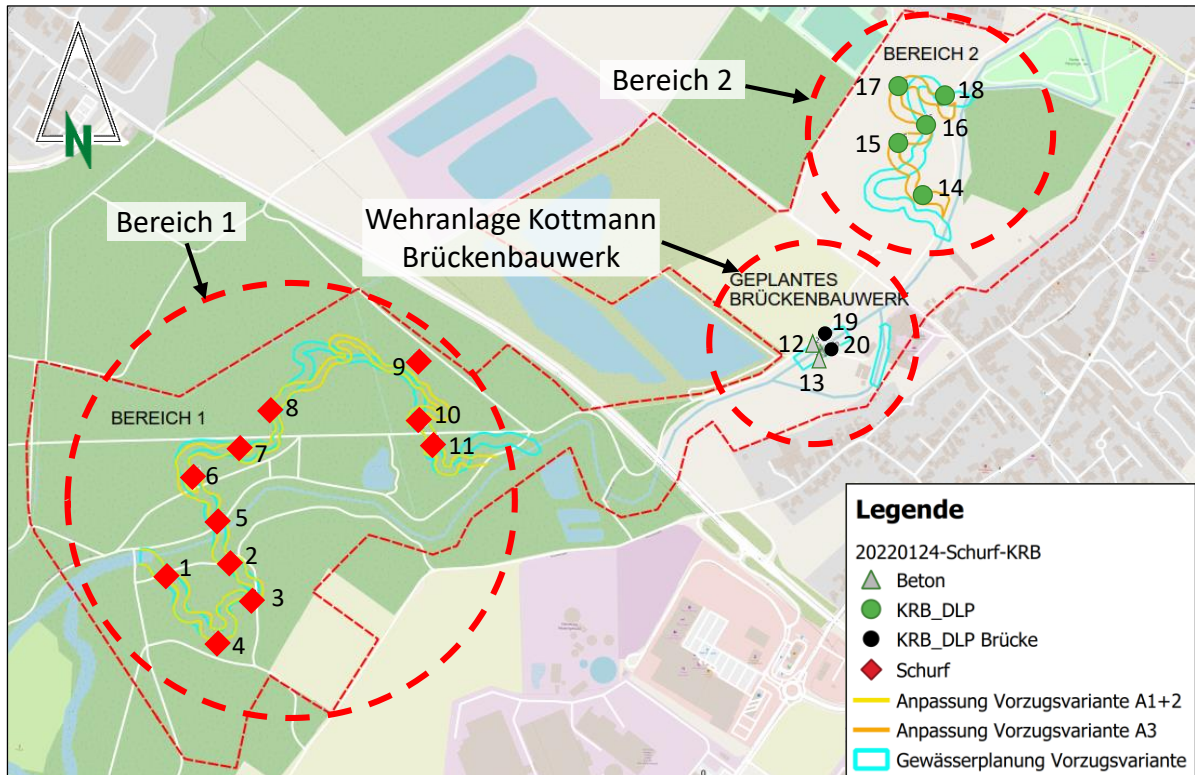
Lageplan Erkundungskonzept Bodenaufbau und -belastungen
